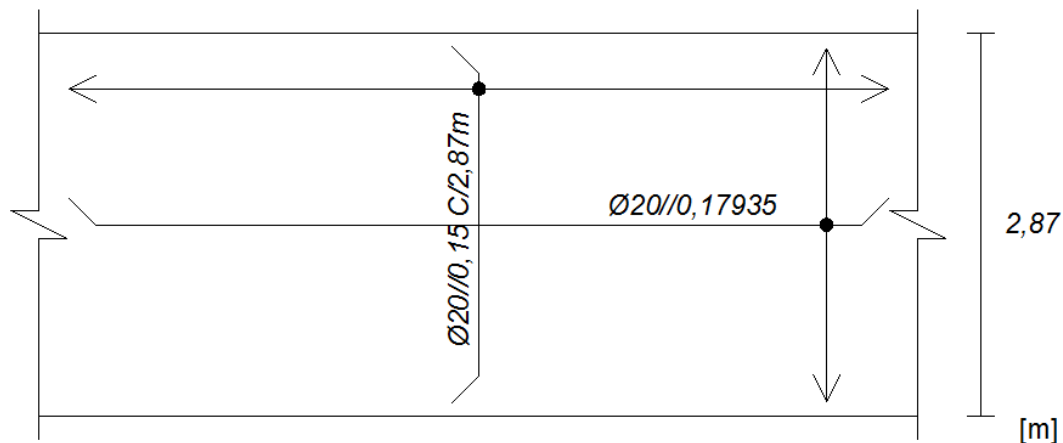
Pormenorização das armaduras ordinárias em planta, da laje com armadura ordinária na linha neutra (Marques, J. 2013)
